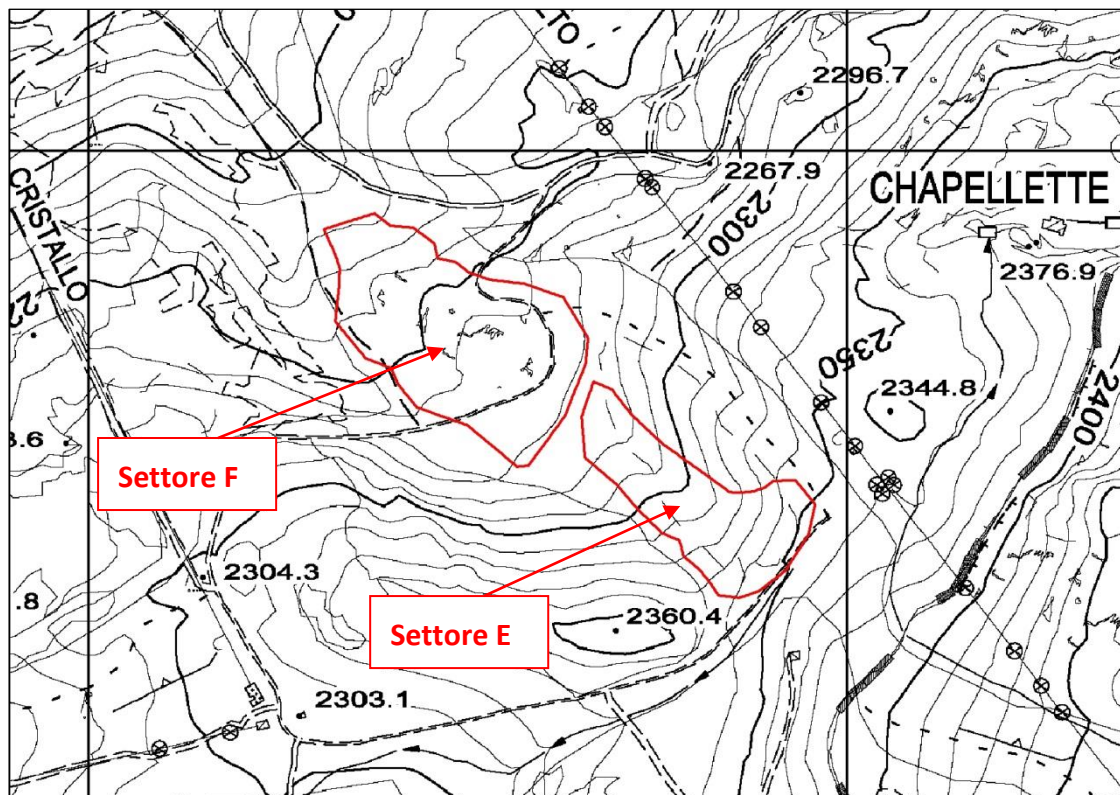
PLANIMETRIA DEGLI INTERVENTI SULLA PISTA N.22 SU BASE CTR CON LOCALIZZAZIONE DEI SETTORI E E F (IN ROSSO)
